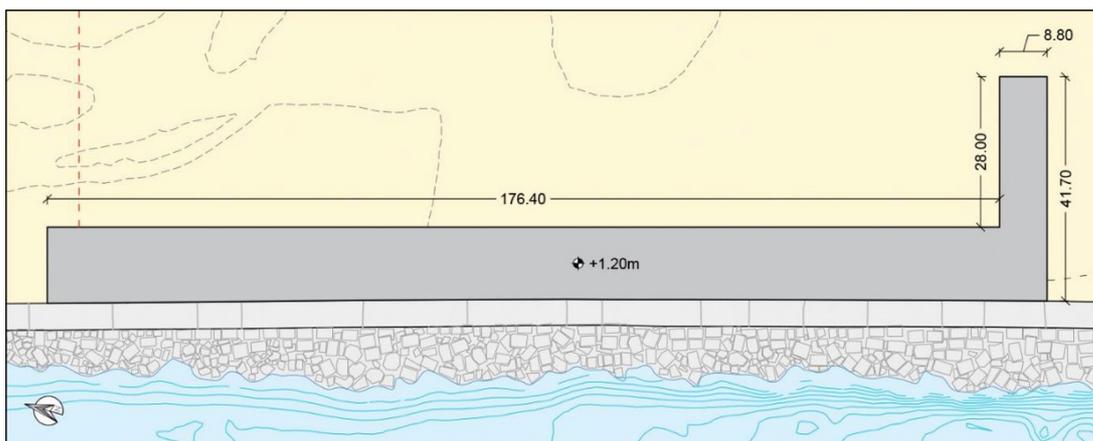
Planimetria opere in progetto - SIGMA 2022
